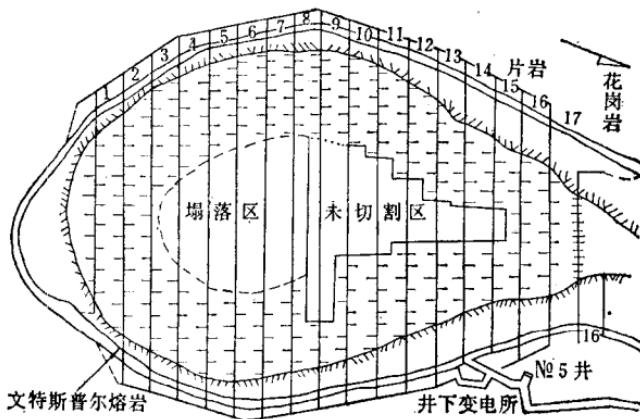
布尔特丰坦矿—580米矿块崩落法平面图
